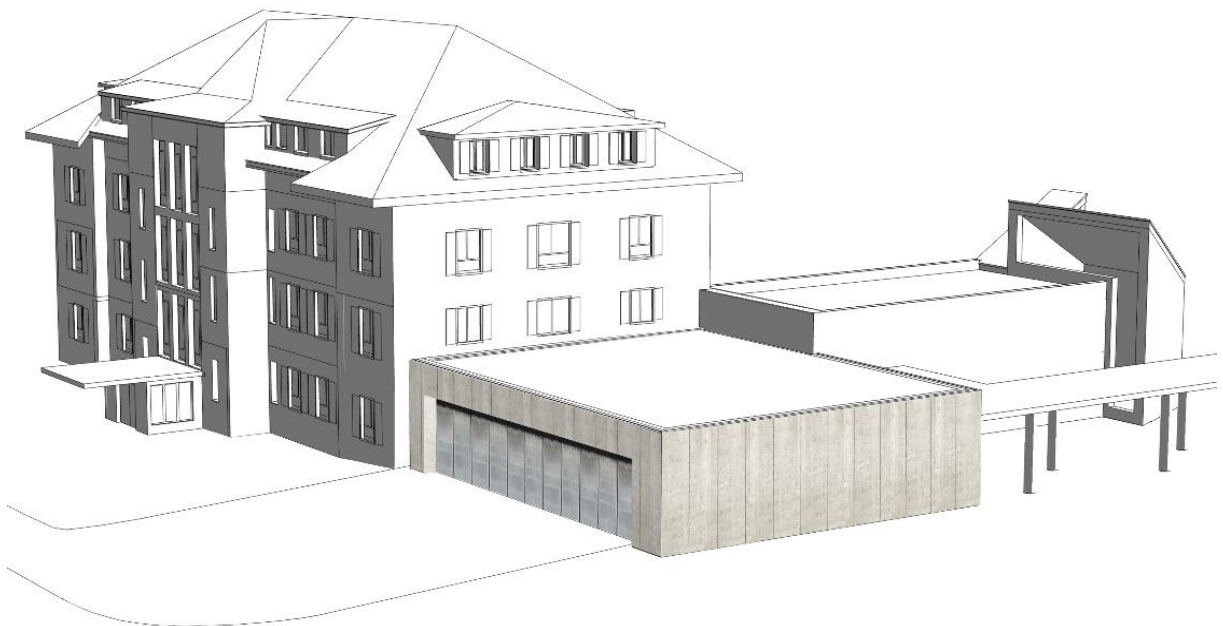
Trakt A mit Anbau Halle Rettungsdienst
